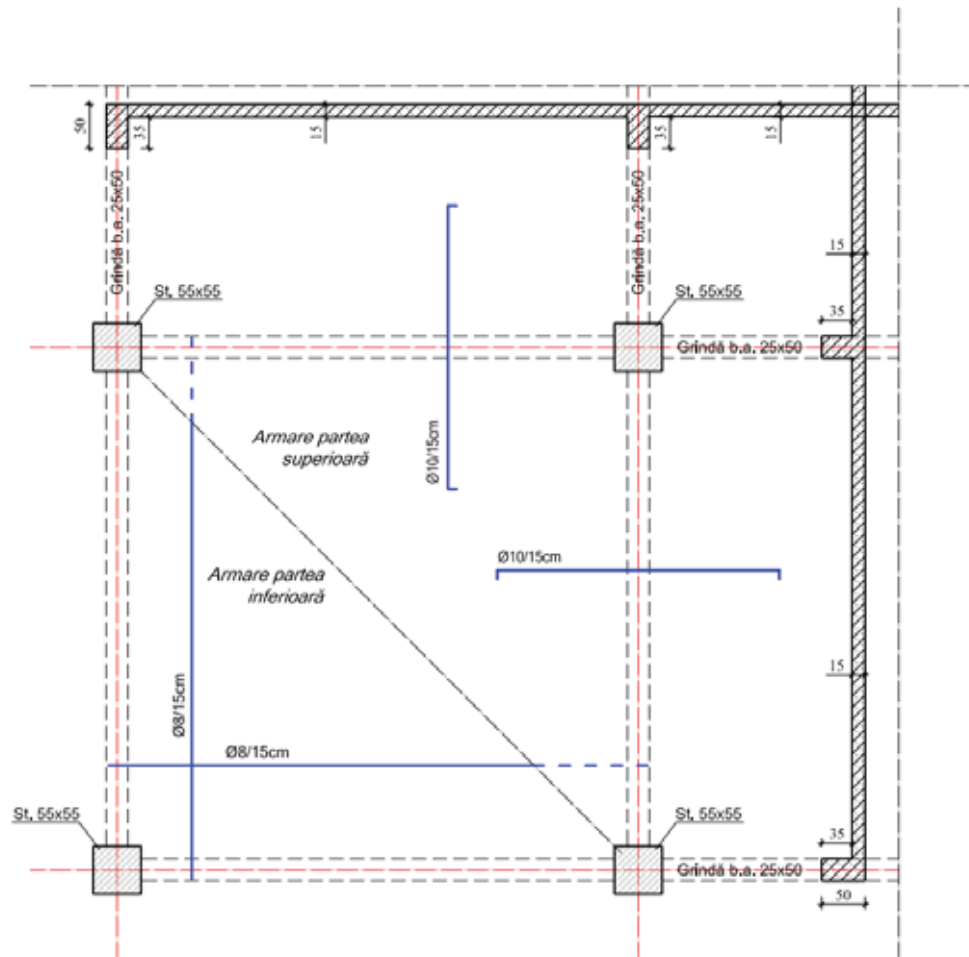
Structură P+5E: plan armare placă b.a.
